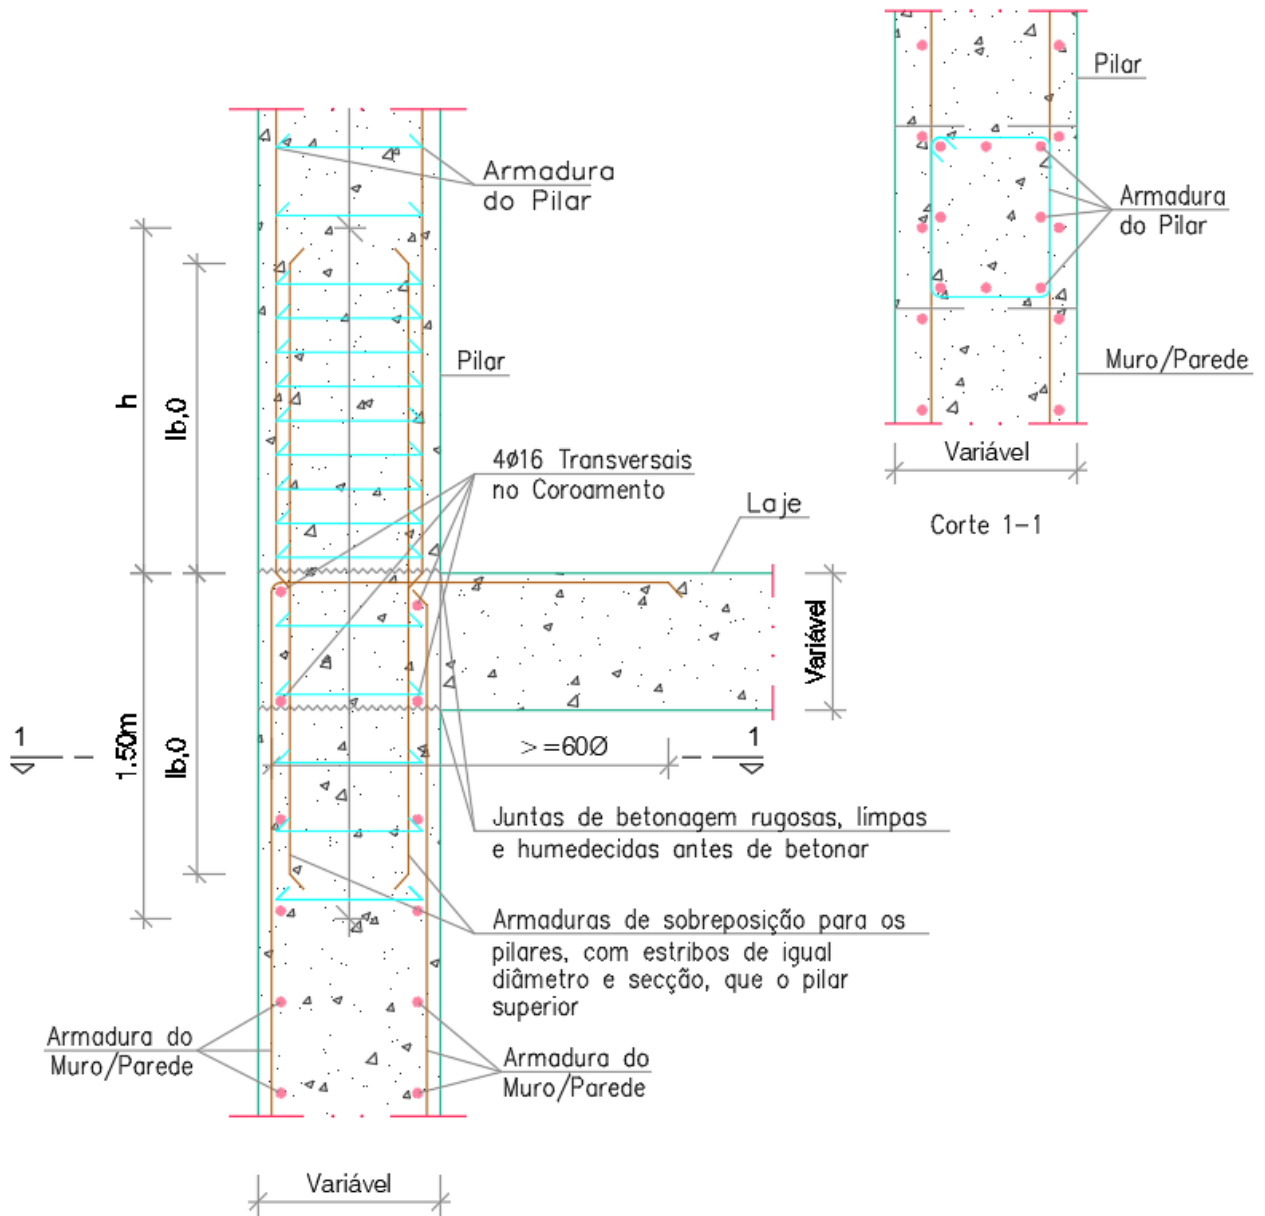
Pilar embecido no muro de igual espessura (Projeto de estruturas).
